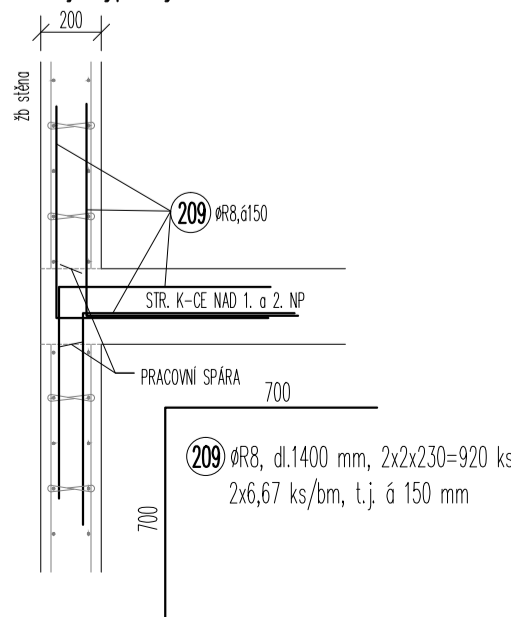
DETAIL vyztužení ukončení schod. stěny – 56 bm
